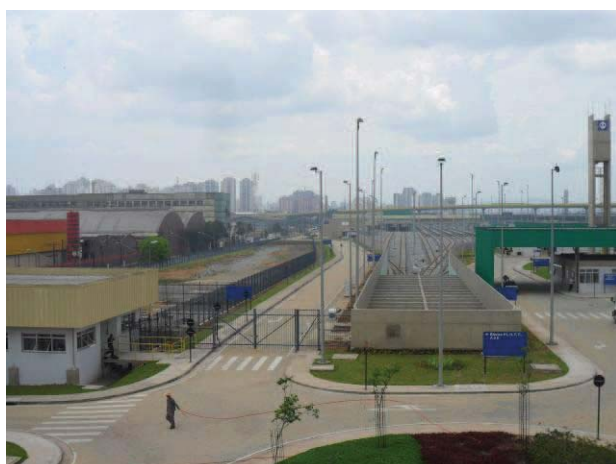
Eixo Ferroviário já existente (linha 10 CPTM) e entorno. Local previsto para implantação do eixo da Linha 18 Bronze, tangente ao eixo ferroviário.
